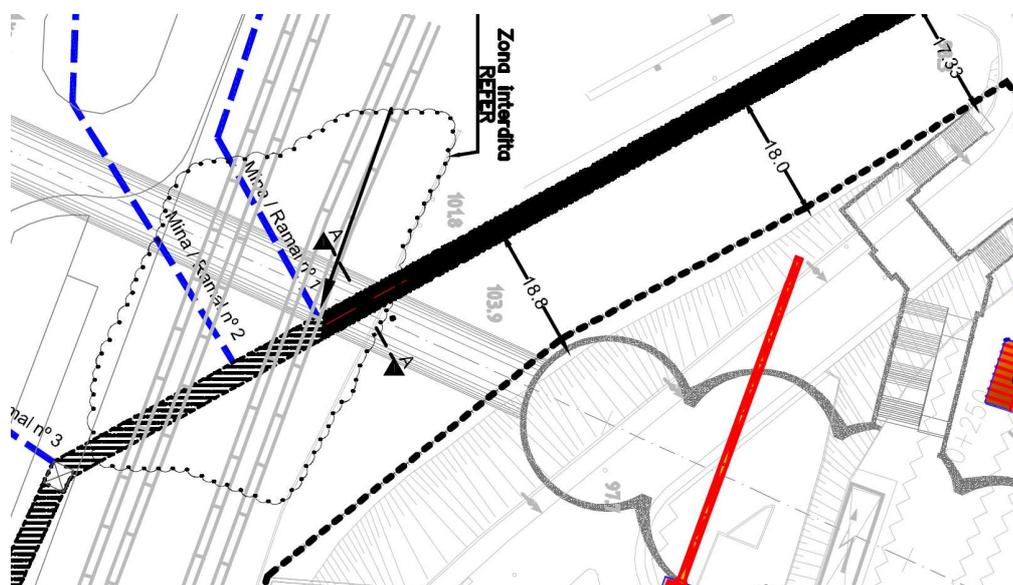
Sobreposição em planta do traçado da linha de Metropolitano e do Aqueduto -
